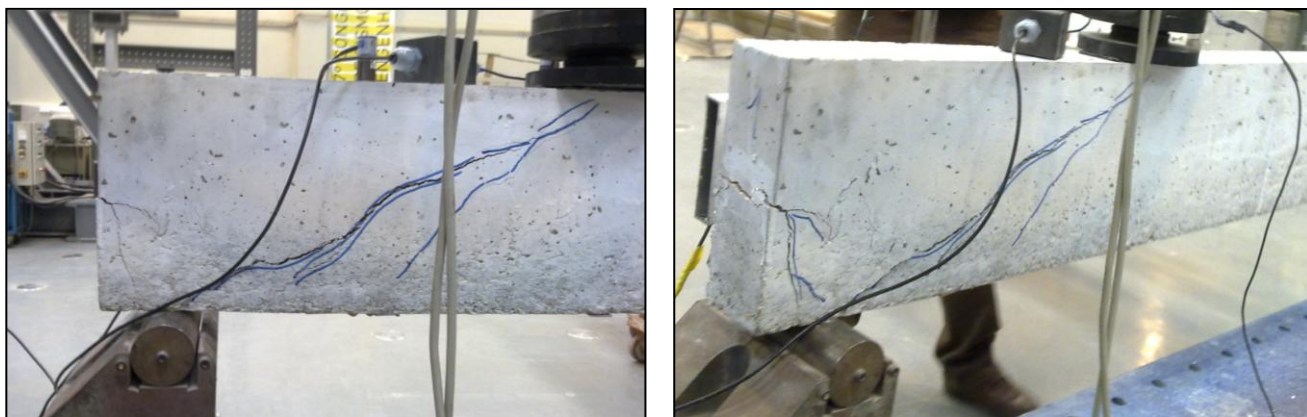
Fissuras de esforço transverso na viga V1
